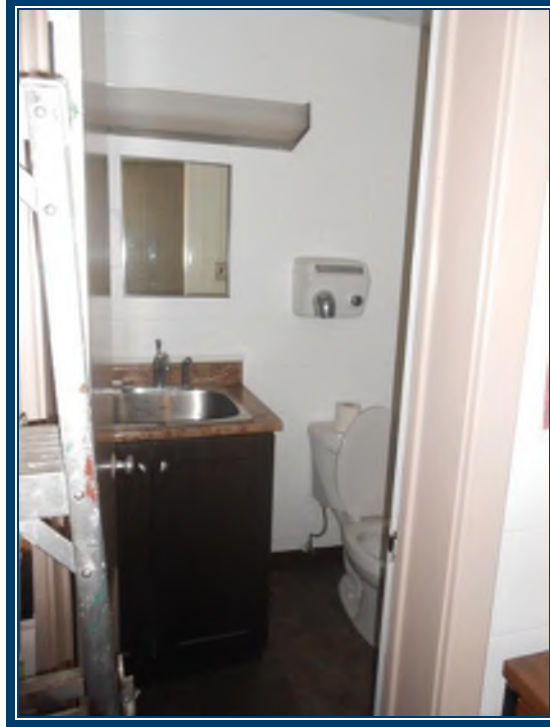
Plancher flottant de la salle de repos/bureau
